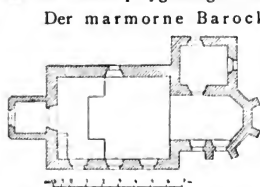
Záboř. Grundriss der ehemaligen Kirche.
